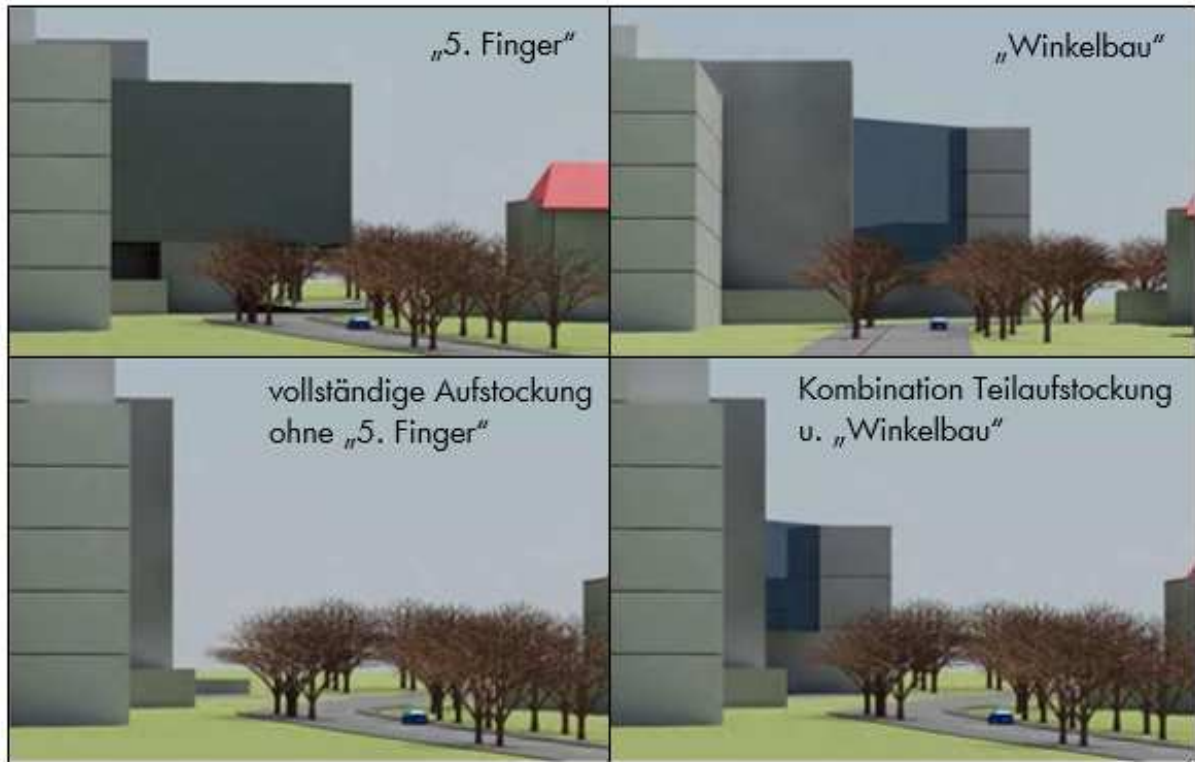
Darstellung der alternative Lösungsvariante „Winkelbau“ des Stadtplanungsamtes (10/2015).
